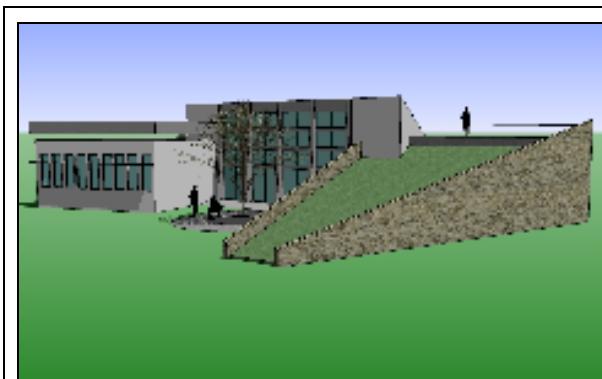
Fachada Principal (Sul) – Acesso à edificação.
